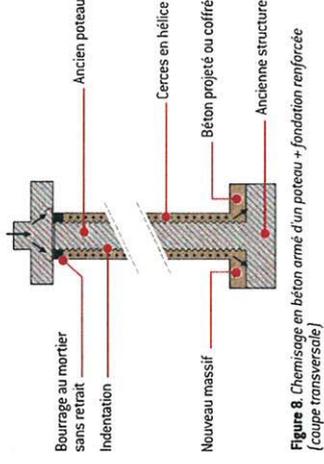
Chemisage en béton armé d'un poteau + fondation renforcée (coupe transversale)
